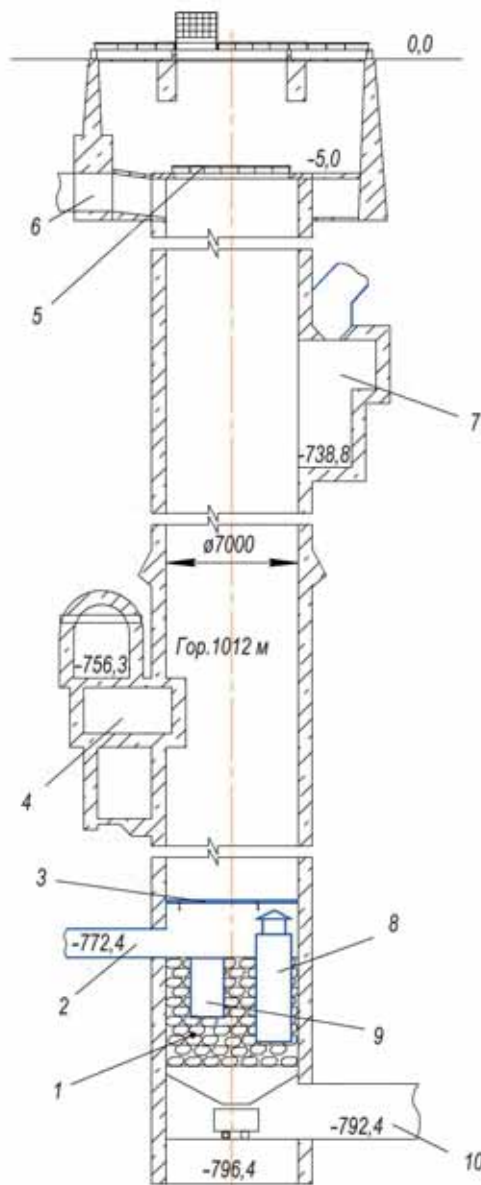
Разрез по стволу после аварии: 1 – щебень; 2 и 10 – ходки для перепуска воды и для чистки зумпфа; 3 – предохранительное перекрытие; 4 и 7 – загрузочные камеры породная и угольная; 5 – перекрытие на отметке $-5,0$ м; 6 – вентиляционный канал; 8 – угольный скип; 9 – противовес породного скипа.
